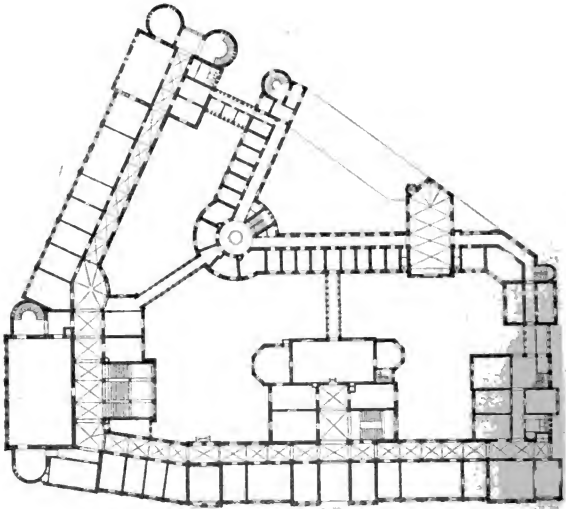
Gerichtsgebäude. Grundriß des II. Stockwerks.
